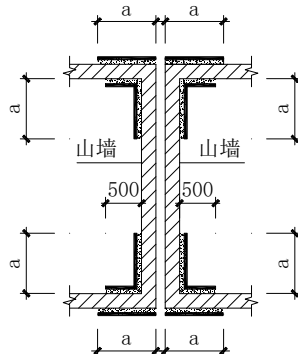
相邻建筑物的端山墙加固平面示意图
